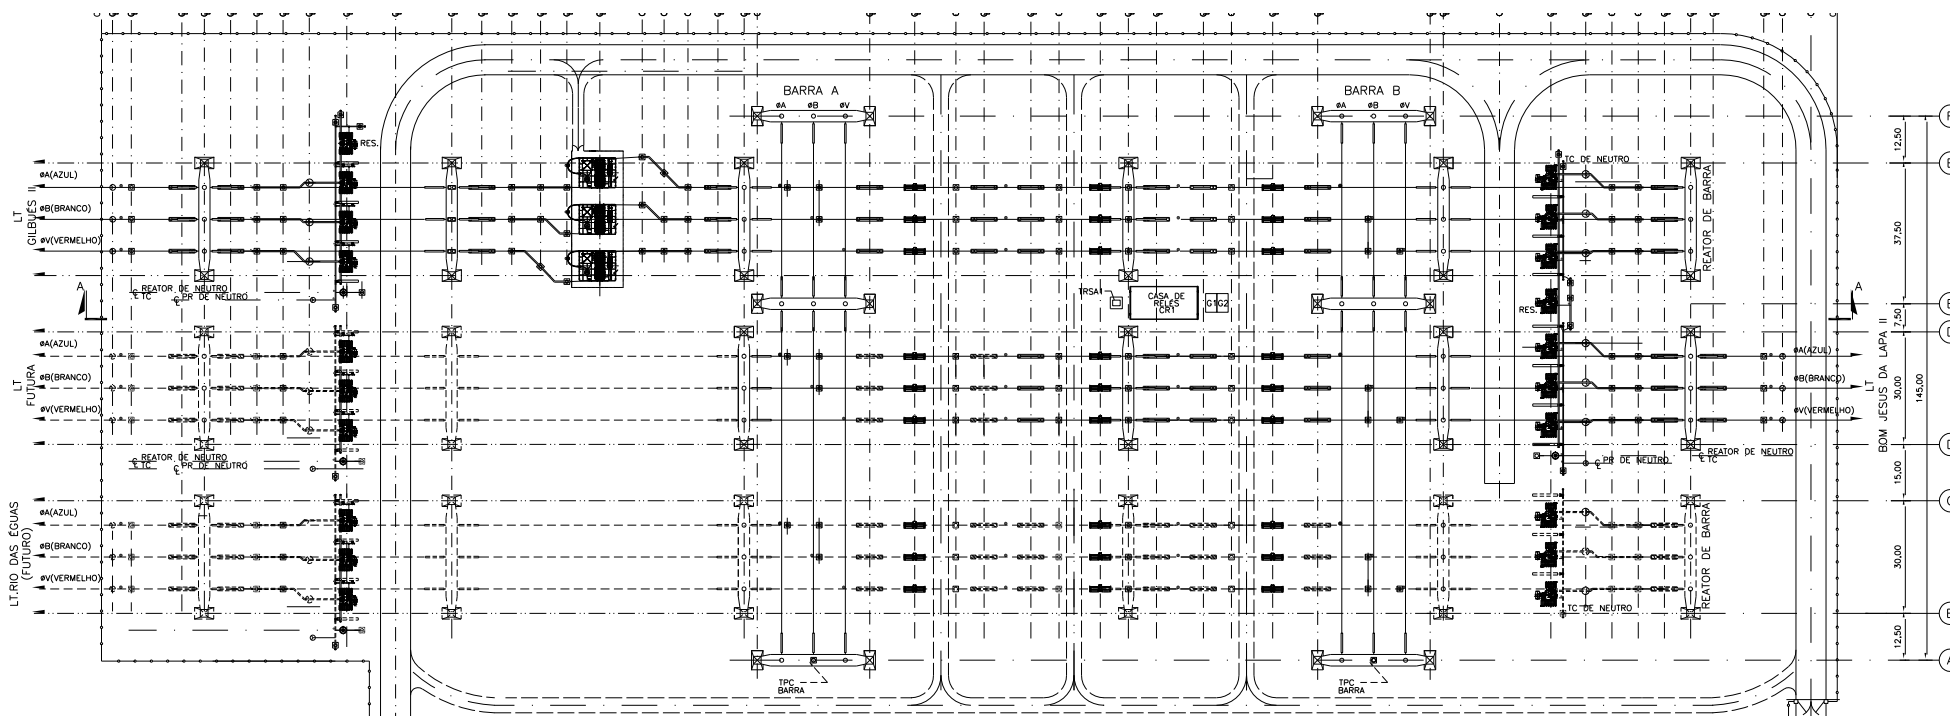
SE Barreiras II - Arranjo Geral da Subestação
